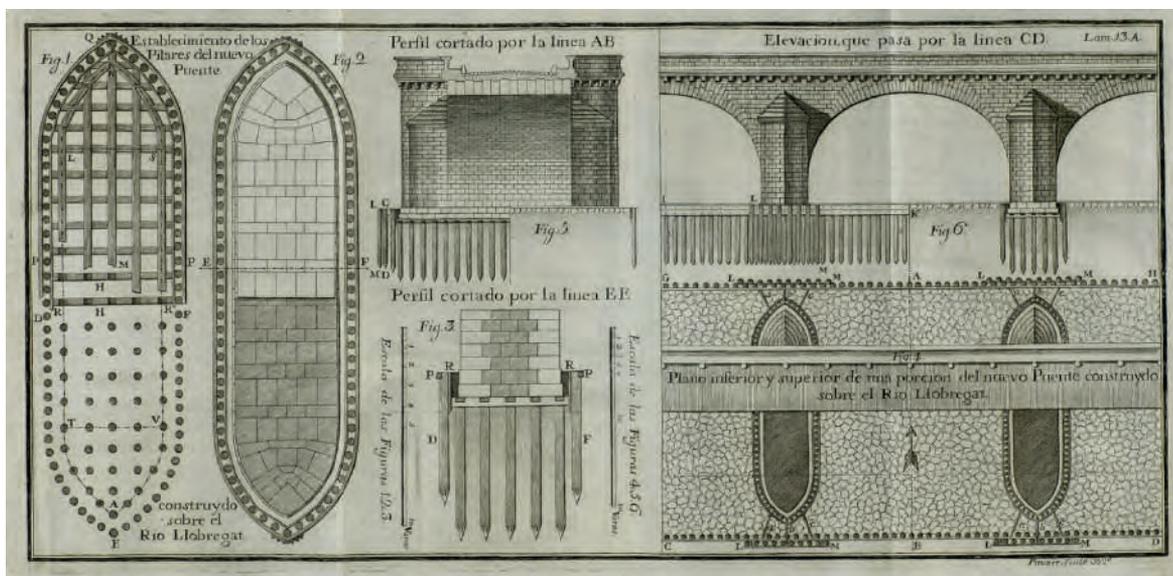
Recintos tablestacados y pilotes hincados de madera en la construcción de pilas en el cauce del río Llobregat (puente de Molins de Rei. Tratado de Sánchez Taramas
